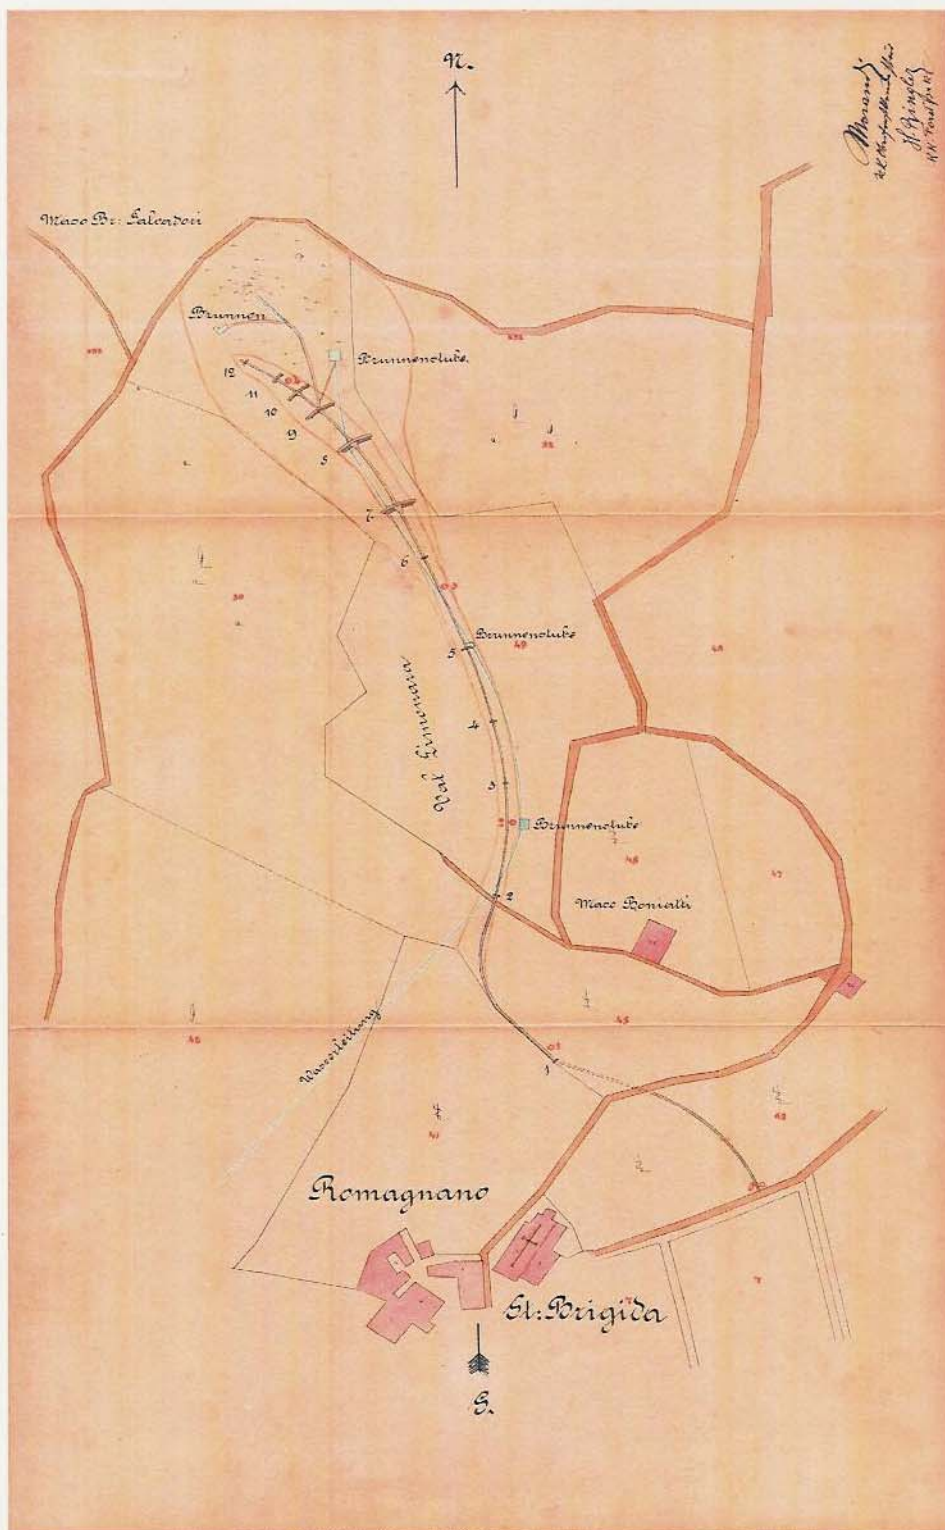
La planimetria degli interventi eseguiti dopo l'evento del 31 marzo 1904, allegata all'atto di collaudo dell'anno 1906.
